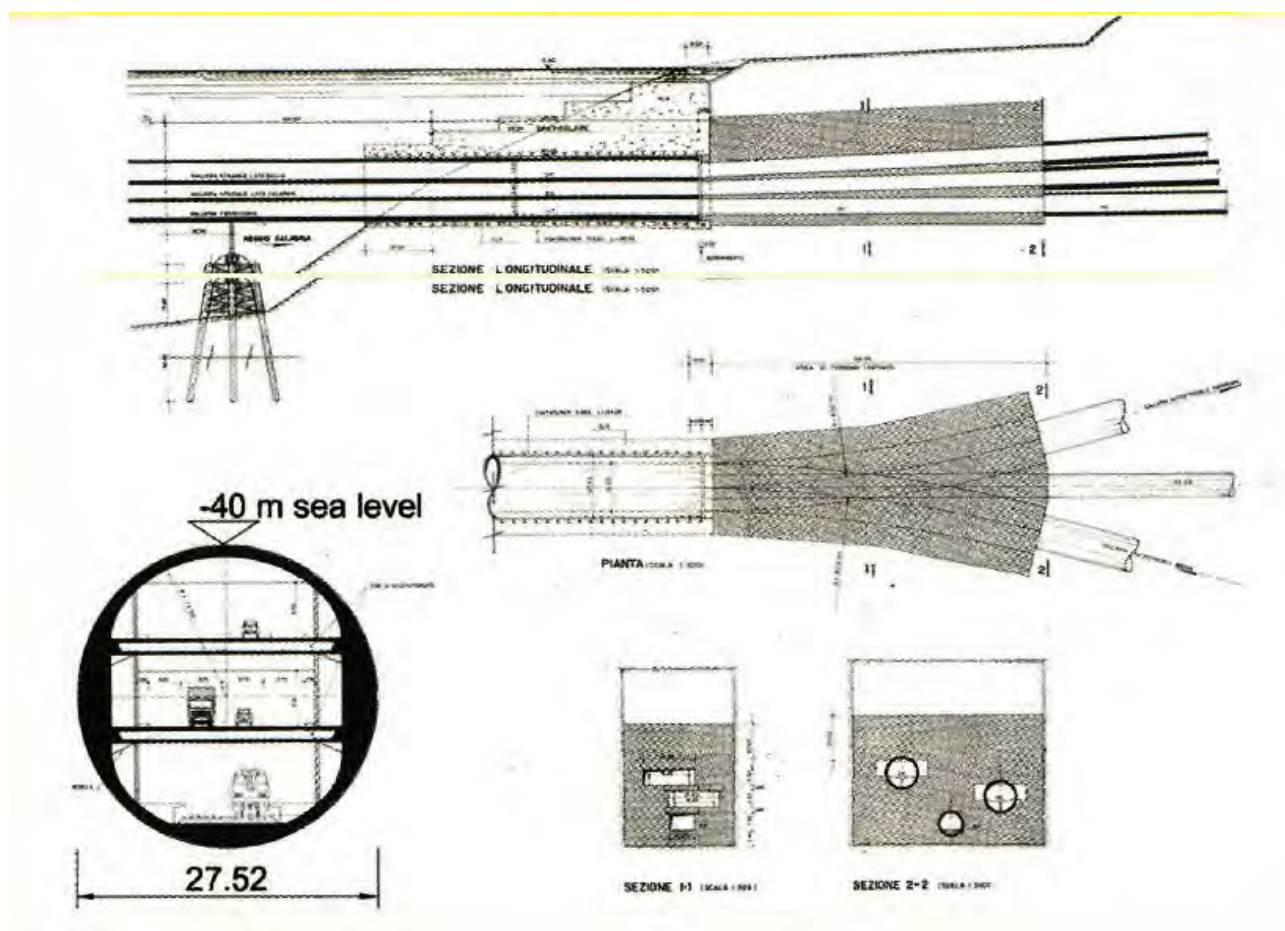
Tunnel a mezz'acqua stradale e ferroviario preso in considerazione dalla SdM.
